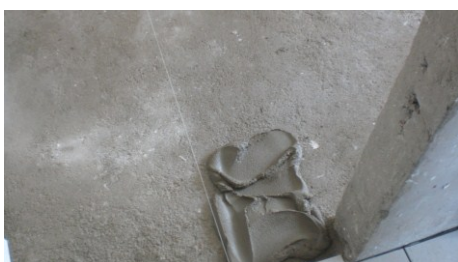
Argamassa colante aplicada sobre contrapiso.
